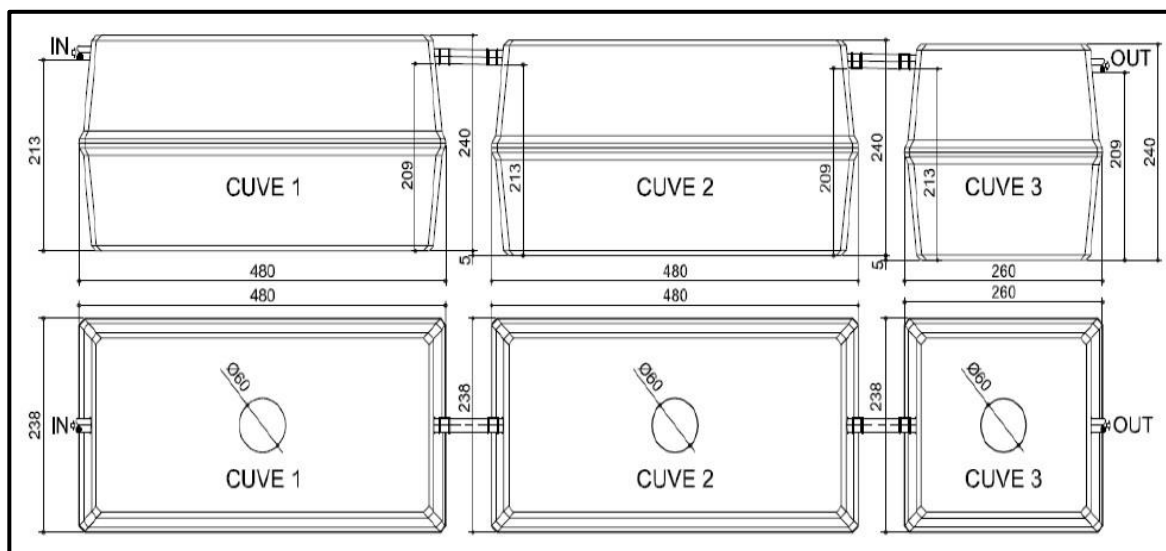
Plan d'encombrement de l'Oxyfix® C-90 CB 99 EH
